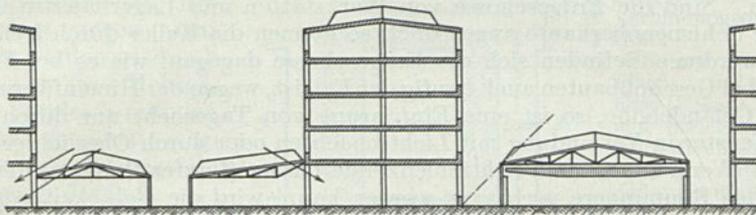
Vereinigung von Mehrgeschoß- und Flachbauten. M. etwa 1 : 1000.
